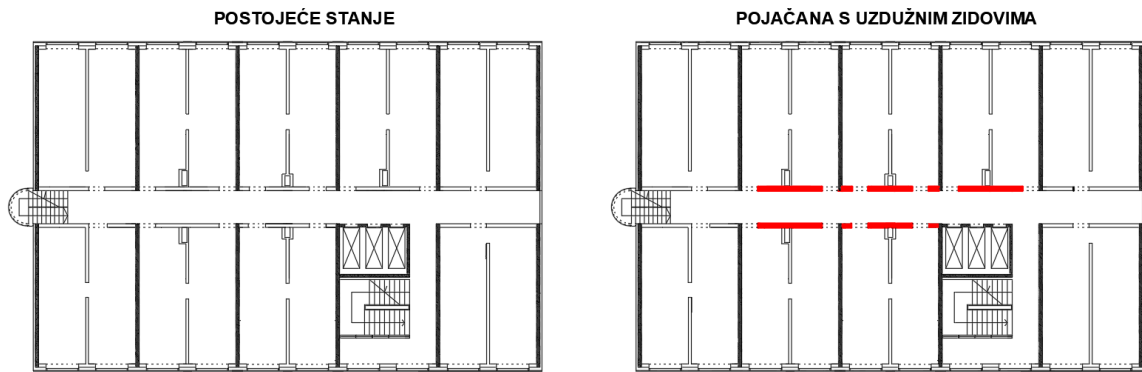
Primjer pojačanja AB okvirnih konstrukcija dodavanjem ukrutnih AB zidova
